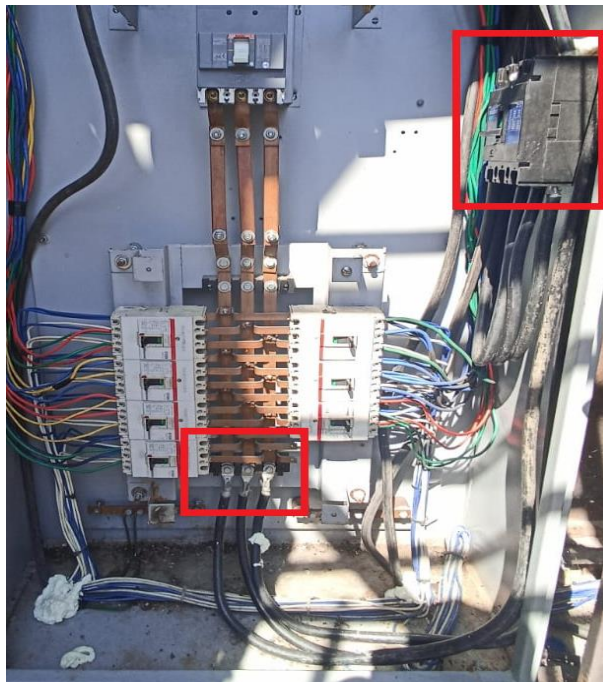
Arquitectura de ubicación de breaker para pórtico.
